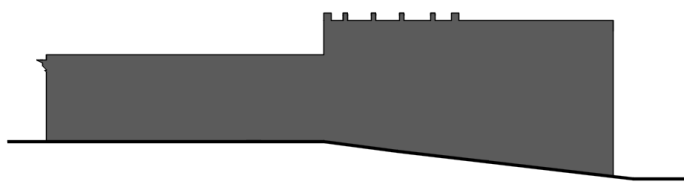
Silueta Urbana Fachada Secundaria Casa Condal de Pérez Gálvez. Elaboración Propia
